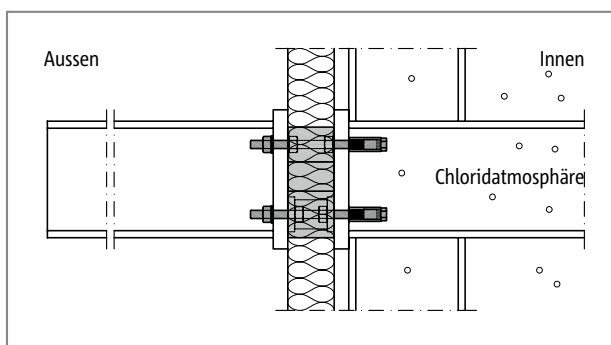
Schöck Isokorb® T Typ S mit Hutmuttern: Stahlkonstruktion frei auskragend; innen chloridhaltige Atmosphäre
